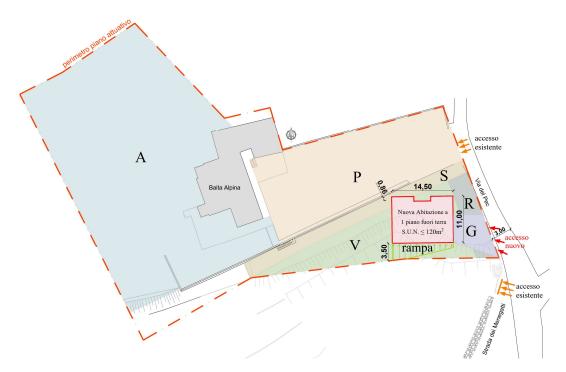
Soluzione inserimento abitazione in perimetro piano attuativo
